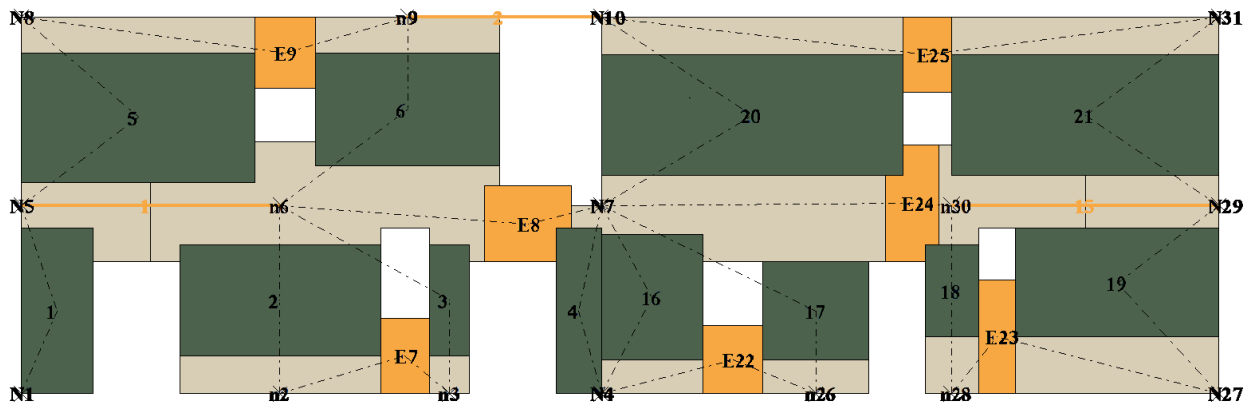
Prospetto Parete 1 - Modello Collegato
